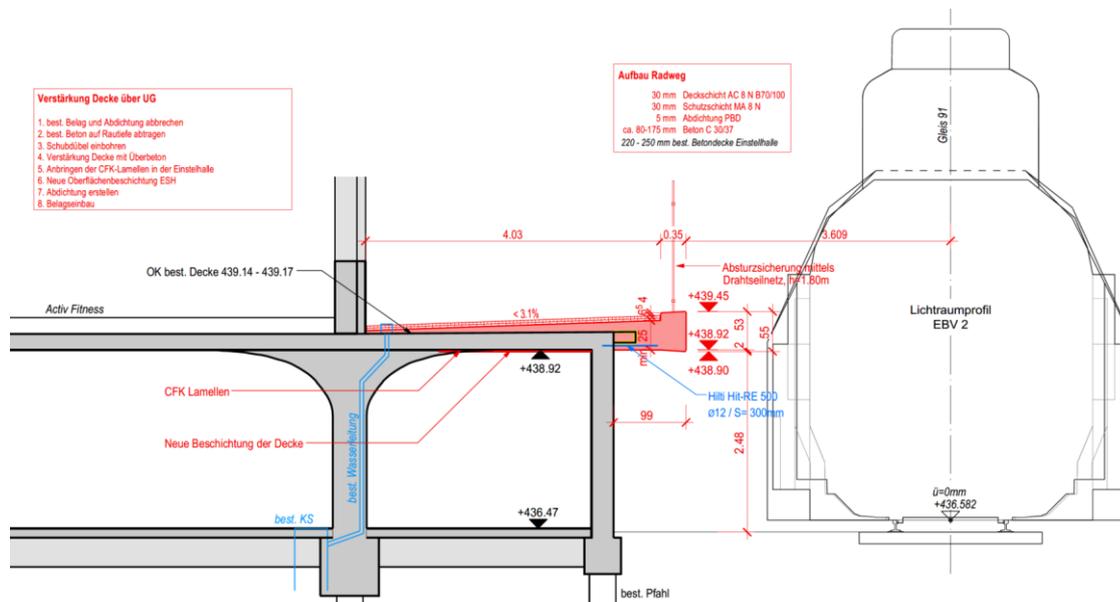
Normalprofil im Bereich des Fitnesscenters – Einstellhalle
